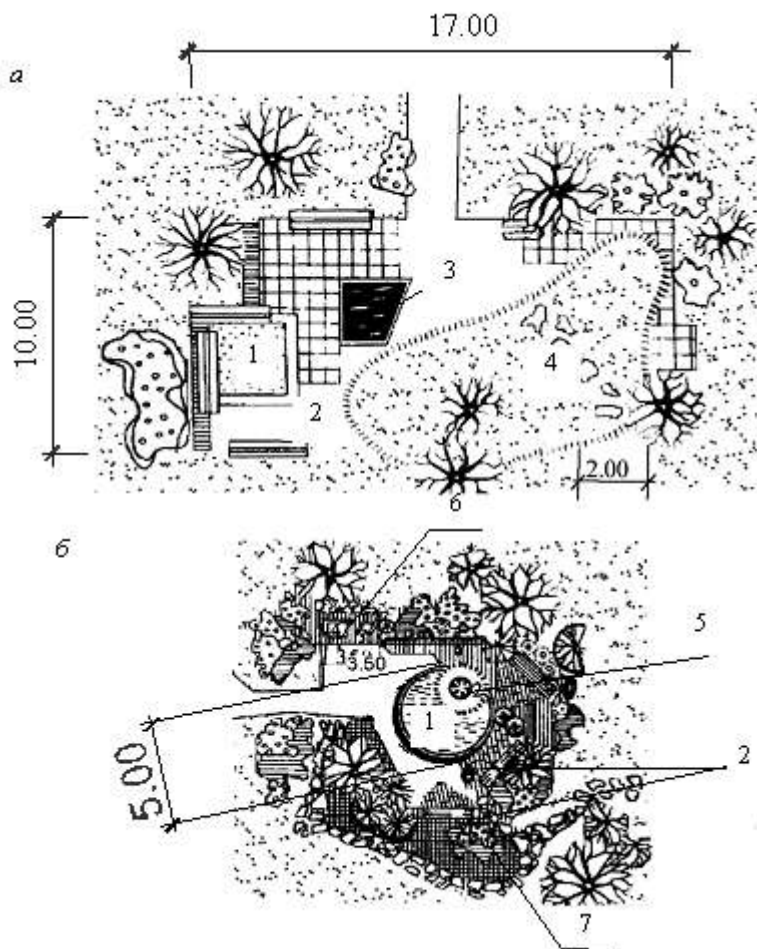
Детские игровые площадки: а – для детей ясельного возраста; б – для дошкольников; 1 – песочница; 2 – скамья; 3 – плескательный бассейн; 4 – газон для игр; 5 – теневой навес; 6 – стол; 7 – трельяж
